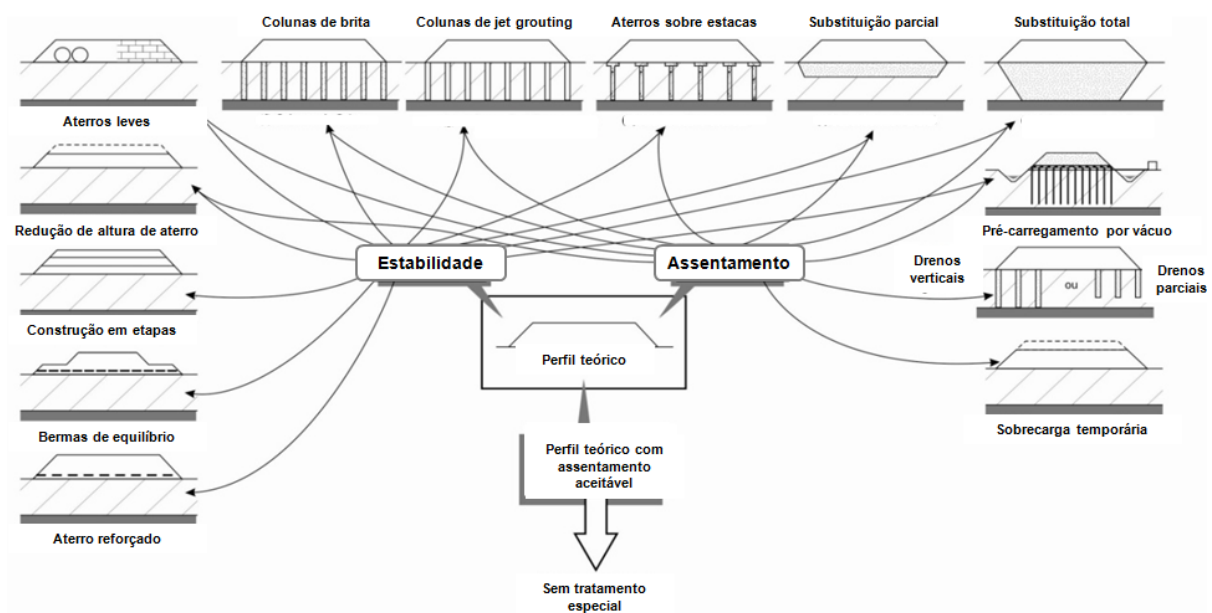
Técnicas de estabilização e controlo de assentamentos na construção de obras sobre solos moles (adaptado de Almeida & Marques (2010))
